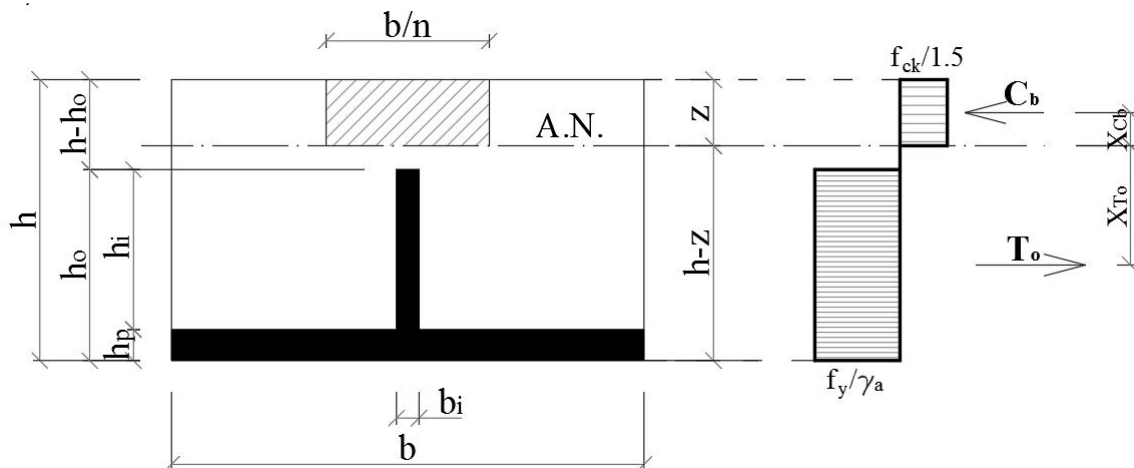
2. Model de calcul al structurii mixte oțel-beton cu structură metalică din platbenzi
